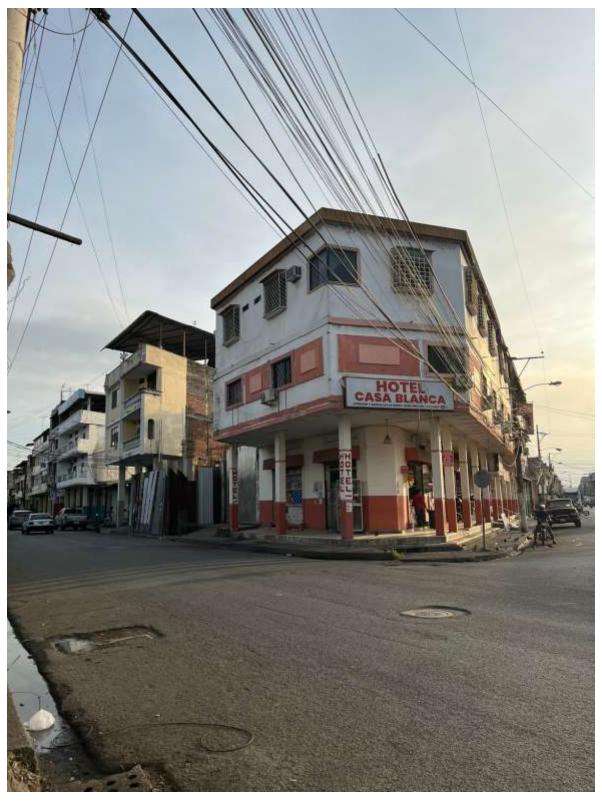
Edificio con irregularidad en planta, ejes estructurales no paralelos. Fuente: Elaboración propia.
